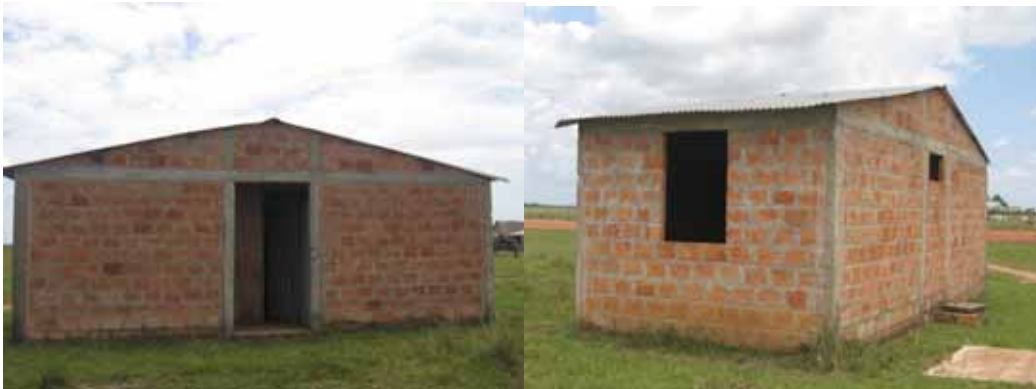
Fachada frontal y lateral del proyecto VISR. Villa Adriana Primavera Vichada
